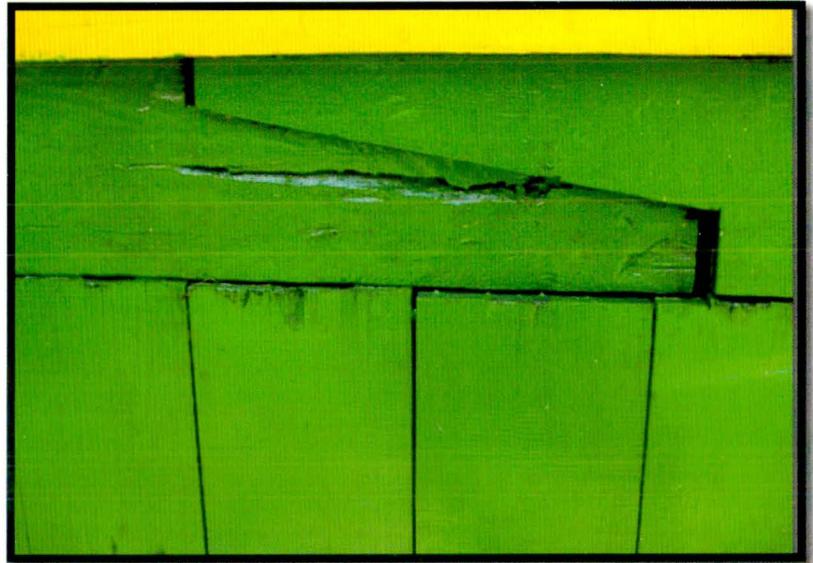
Teknik sambungan balok kayu pada gelegar bangunan
